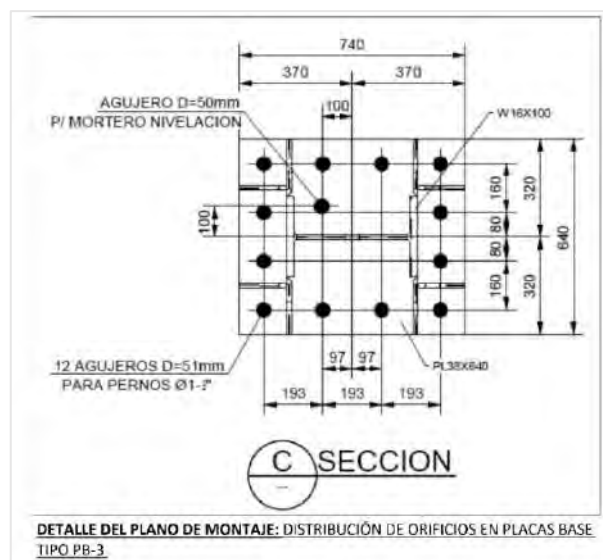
Disposición de pernos de anclaje en Plano de montaje de estructura
